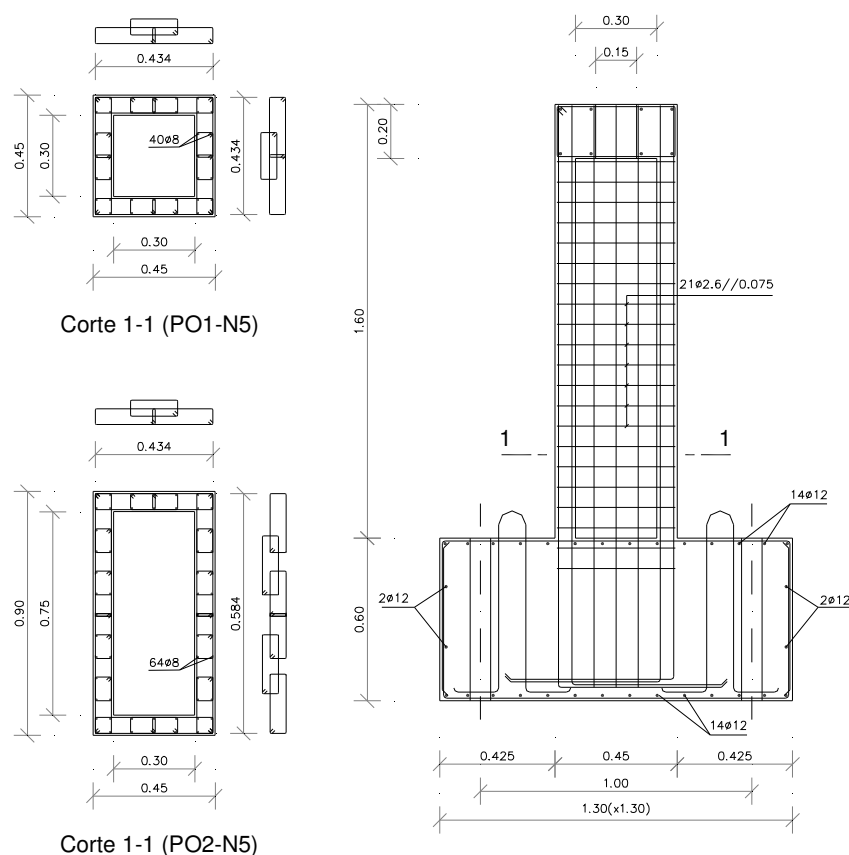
Pilares N5 em betão armado (Escala 1:4)
